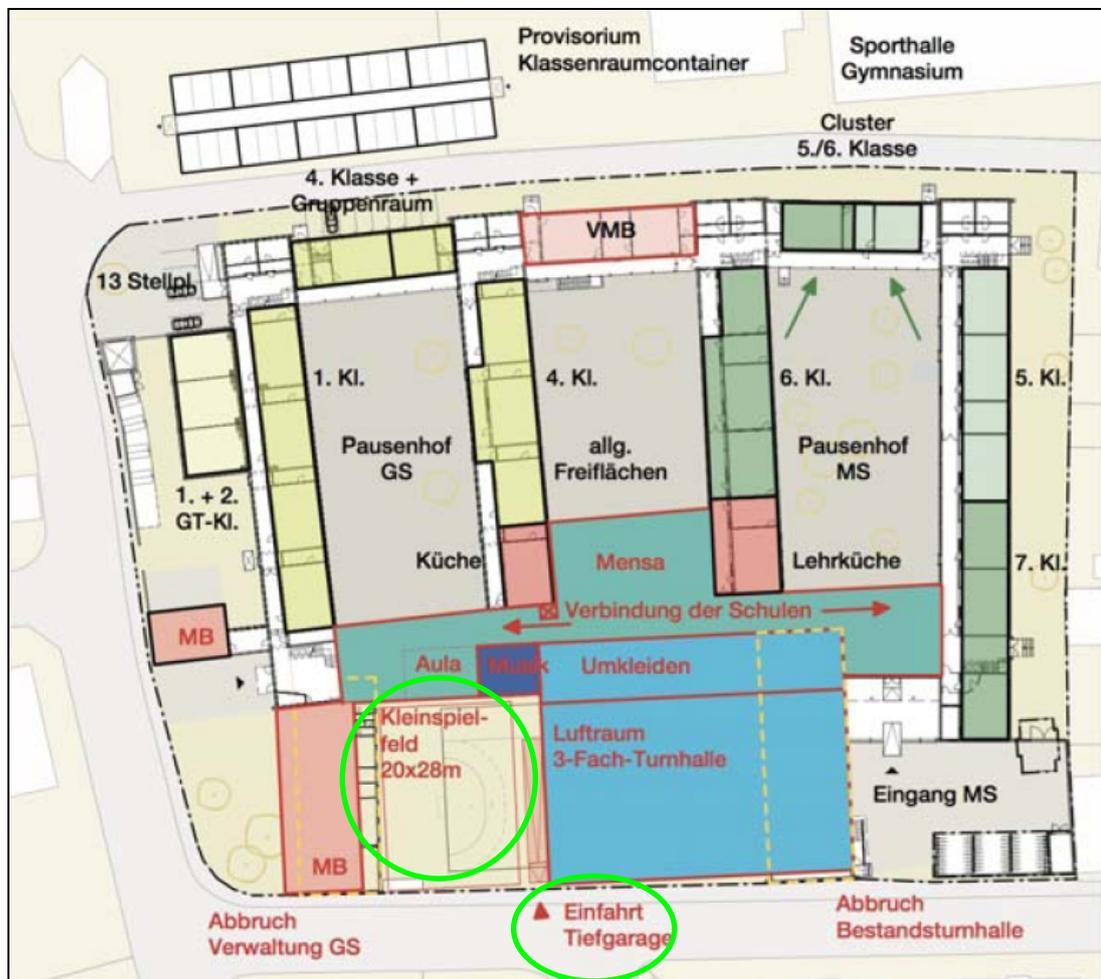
Lageplan mit Kleinspielfeld und Einfahrt zur Tiefgarage (grün umrandet)
